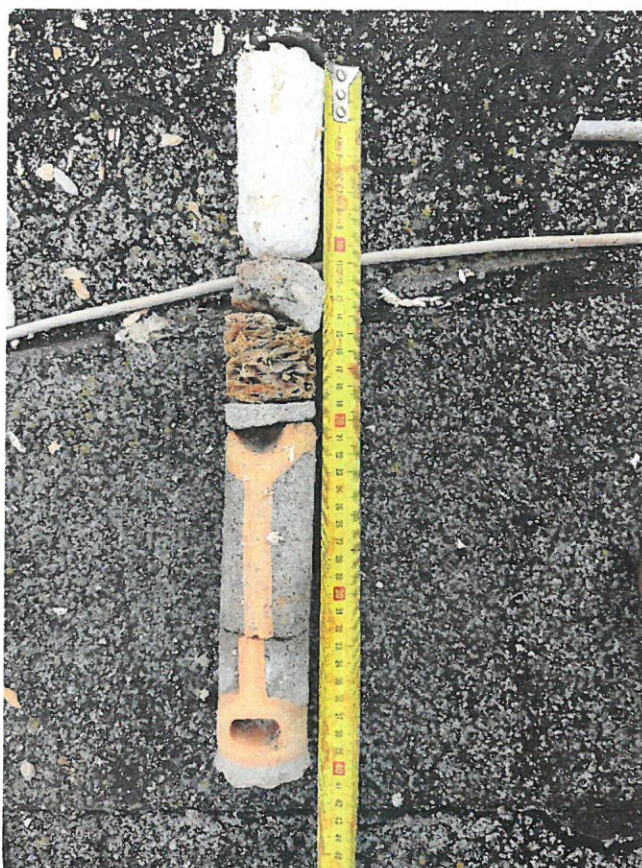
Lokalizacja odwiertu nr 3 – dach łukowy
